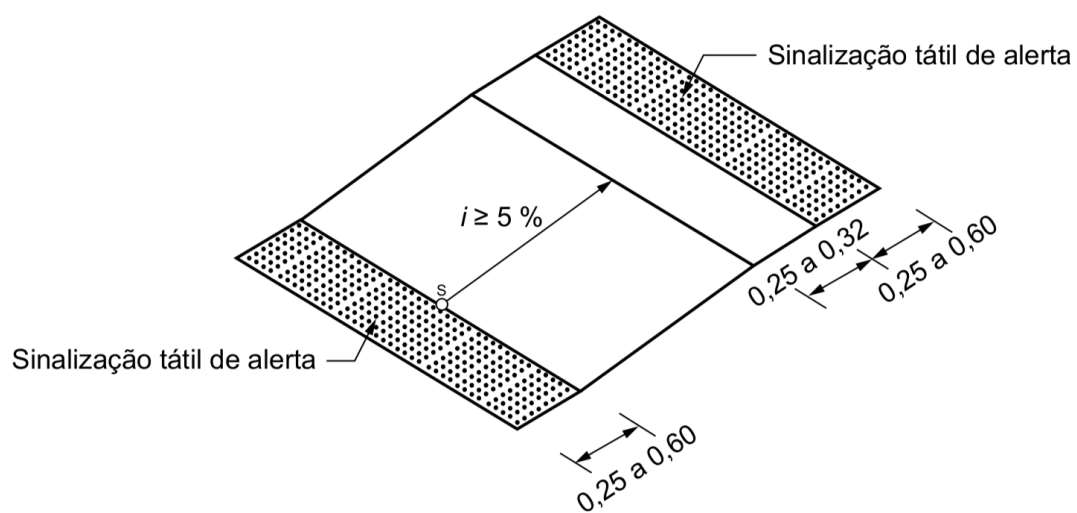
Sinalização tátil de alerta: rampa. Fonte: NBR 16537/2016
